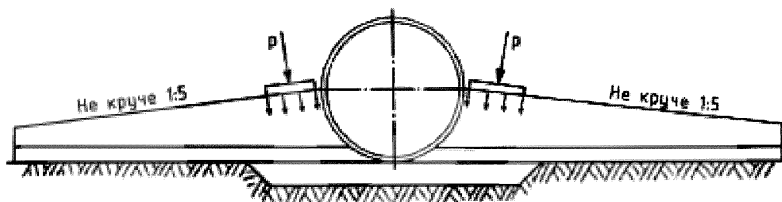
Схема засыпки и уплотнения грунта наклонными слоями
